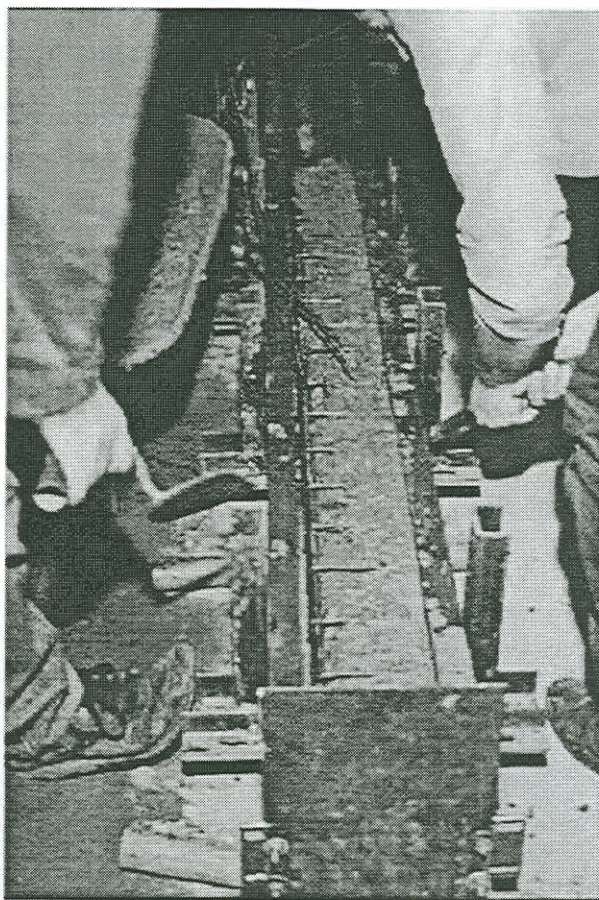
Concretagem dos reforços, preenchimento por um dos lados e vibração enérgica.
